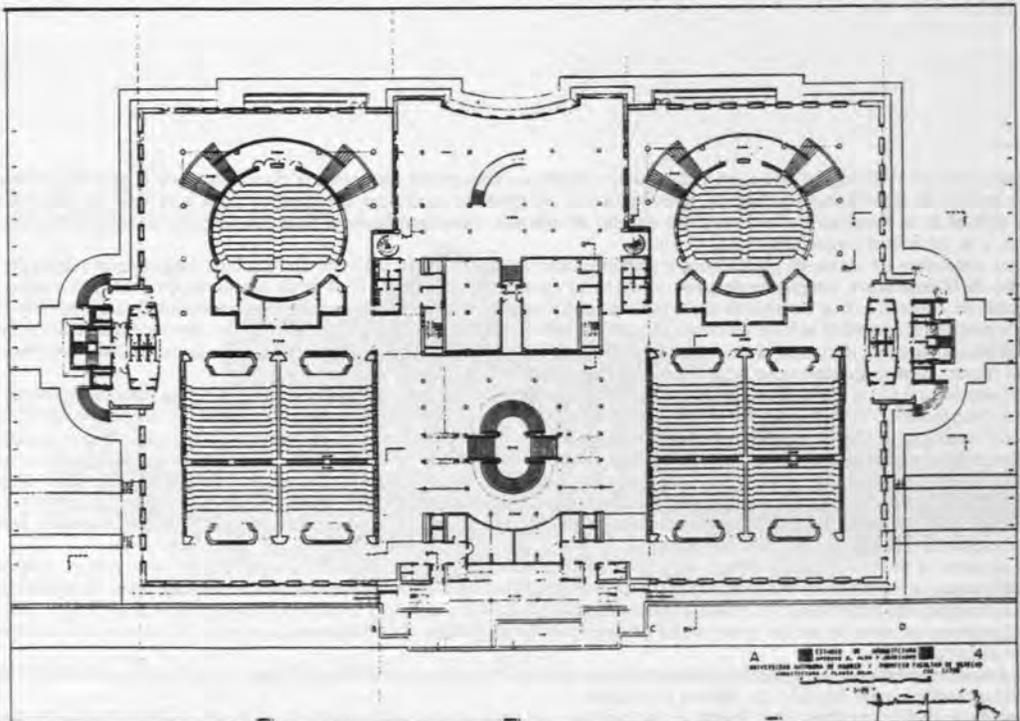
Antonio Fernández Alba: Proyecto de Facultad de Derecho. Planta baja. Escala 1/200.
